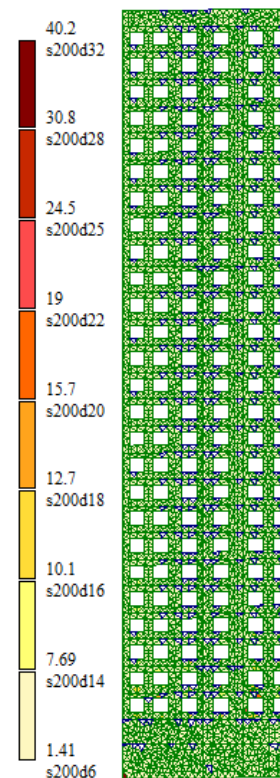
Схема армирования стен по оси Y (у нижней грани)
